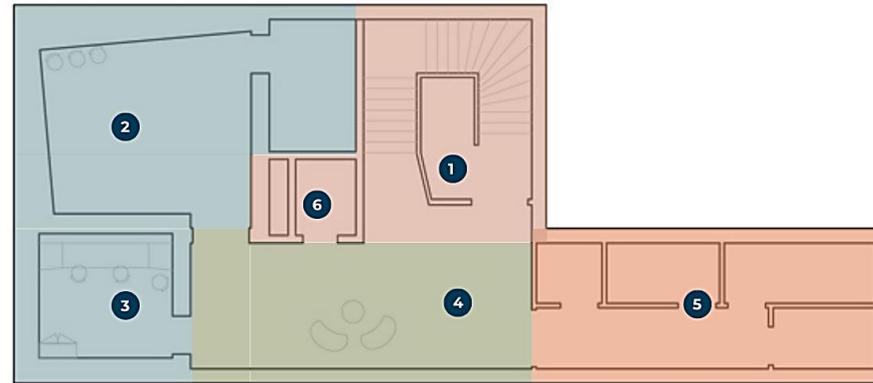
Planta baixa subsolo Centro Cultural *Paris Anim
